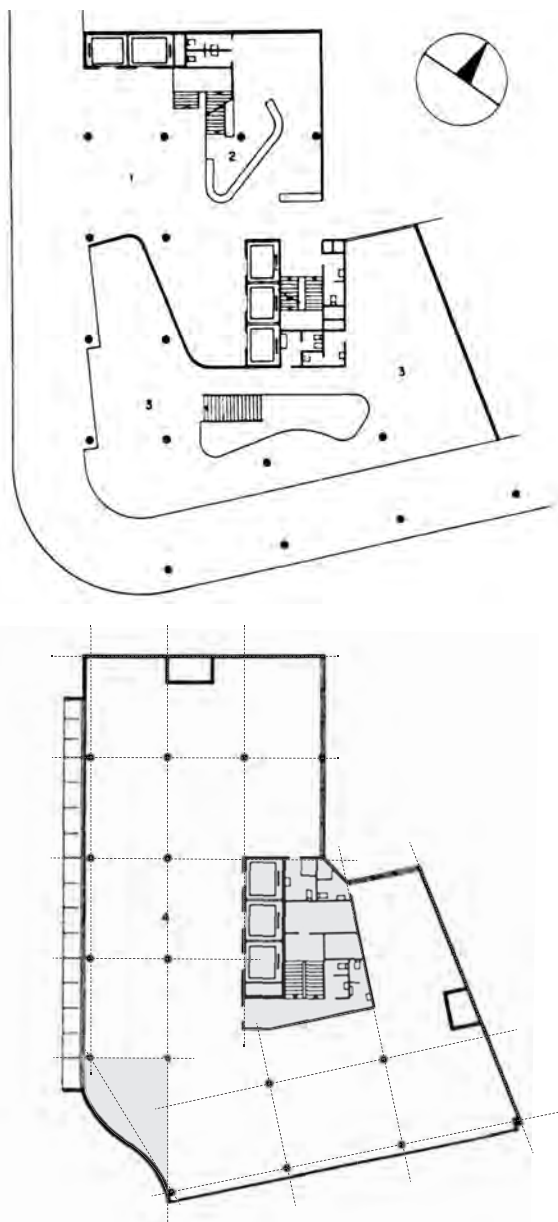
MMM Roberto: Edifício Seguradoras, Rio de Janeiro, 1949-50. Plantas do térreo e pavimento tipo, com a indicação do balanço na esquina e o núcleo de circulação. [MINDLIN, 2000]:237
